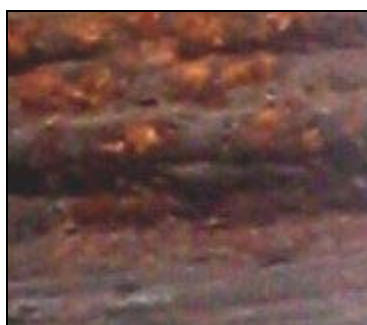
Pormenor de zona de corrosão num cabo principal.
